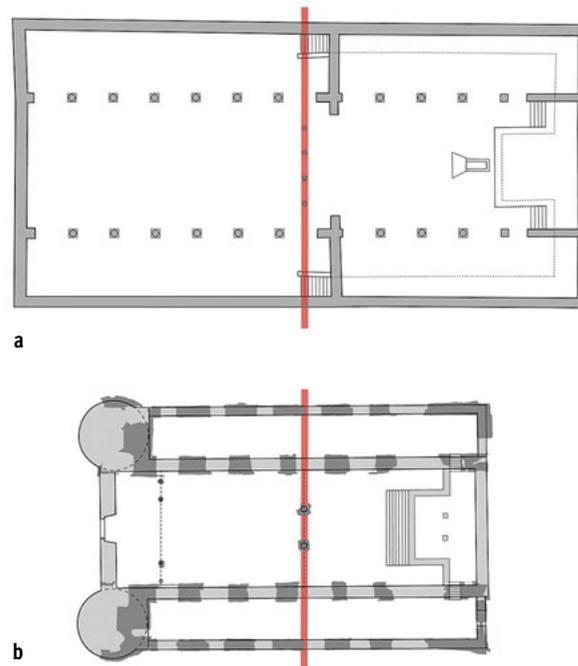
Querunterteilung, häufig in halber Grundrisslänge, trennt oft bei frühmittelalterlichen Kirchen Chor und Laienschiff.
